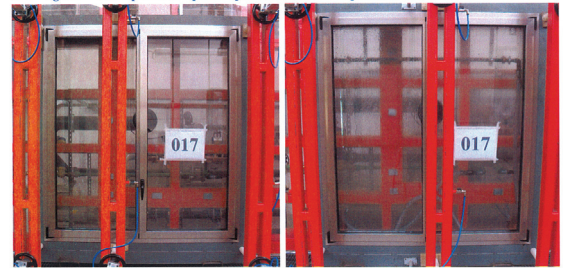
e 2: Campione sottoposto a prova nell'assetto sperimentale e durante i test di tenuta all'acqua sotto pressione statica
